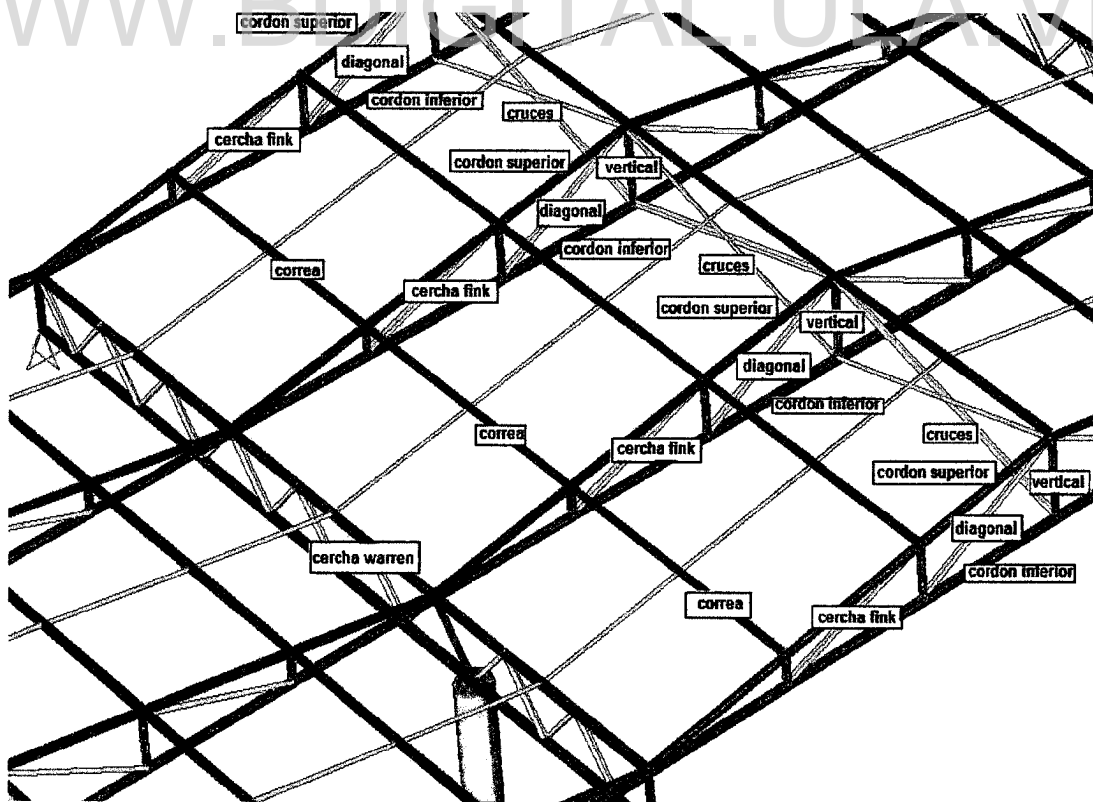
, Detalle modelado de estructura metálica para techo liviano frontal entre ejes A y B.
